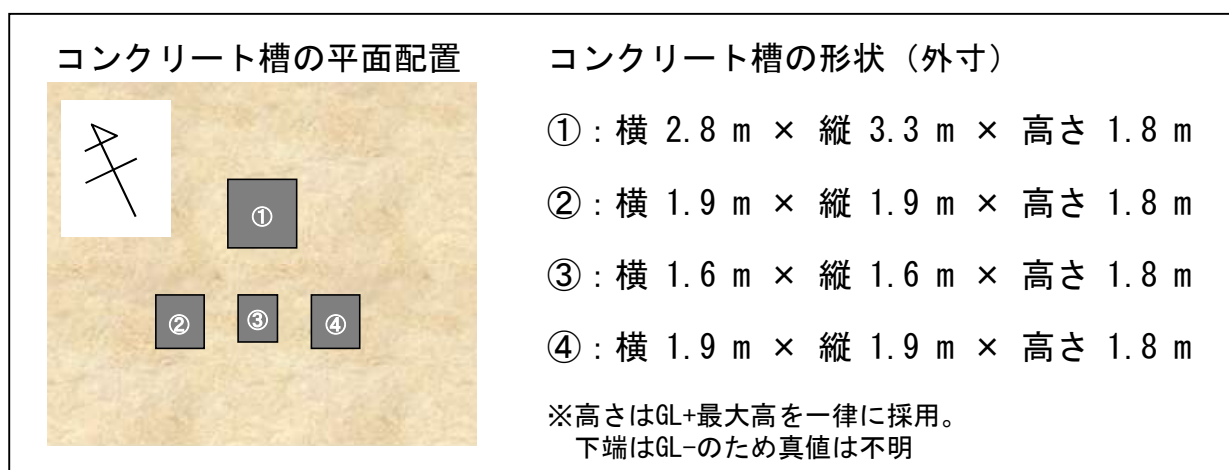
コンクリート槽の配置概略図（図 3-2 を再掲）
